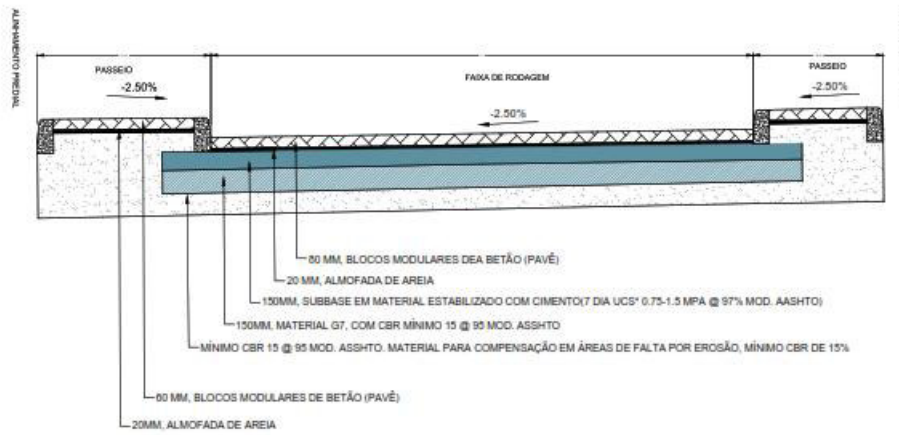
Secção da estrutura de pavimento recomendada (Colectores/Sumidouros)
